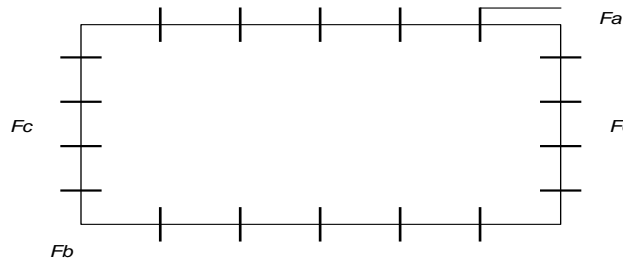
Армирование плиты на опоре (верхняя арматура)
